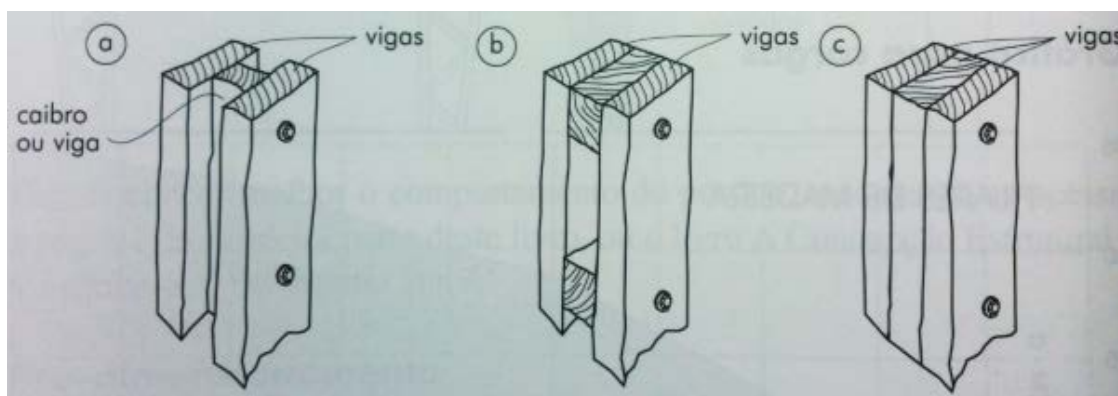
Ligação comum entre vigas e pilares (viga x pilar) de madeira.
